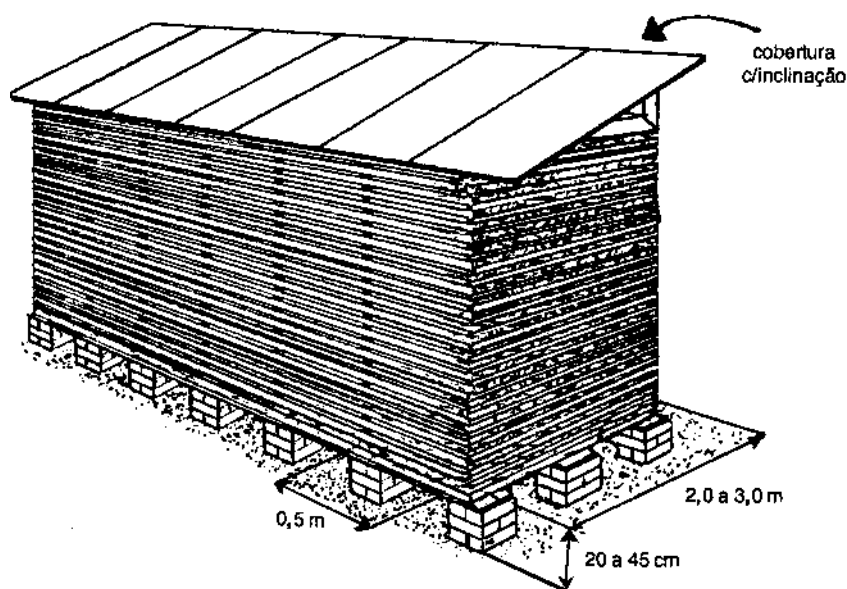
Empilhamento padrão (“gradeado” ou “tipo caixa”).
